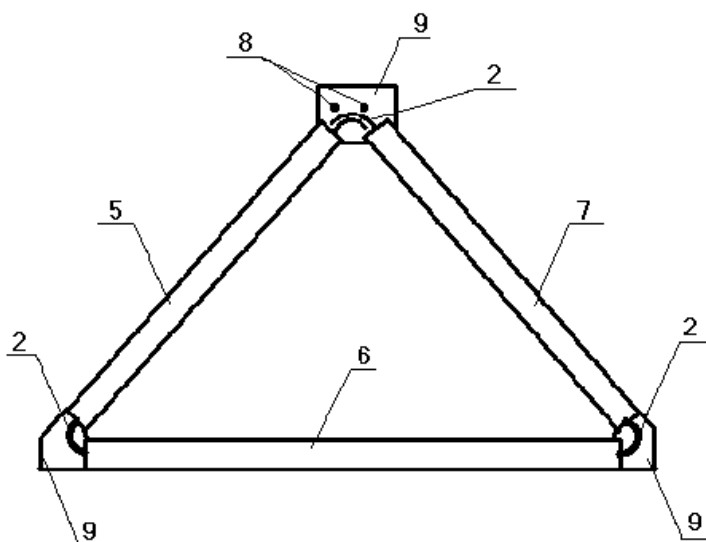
Сечение сборно-монолитной железобетонной балки полой треугольной формы
